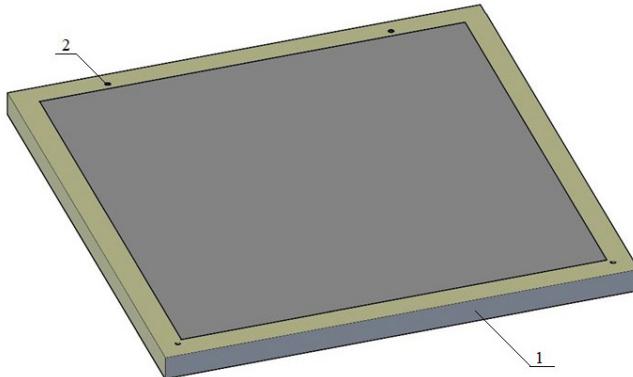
Рядовая сталежелезобетонная плита перекрытия:
